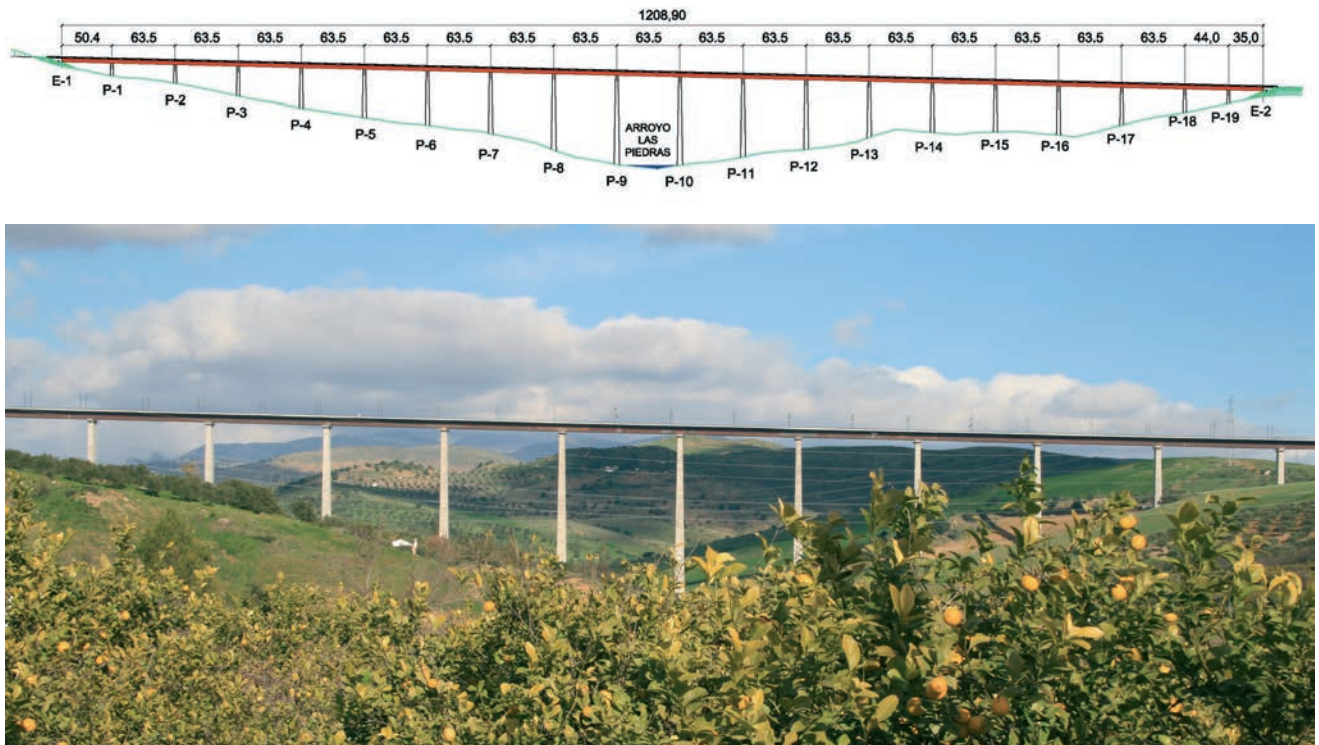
Alzado y vista del Viaducto Arroyo las Piedras
